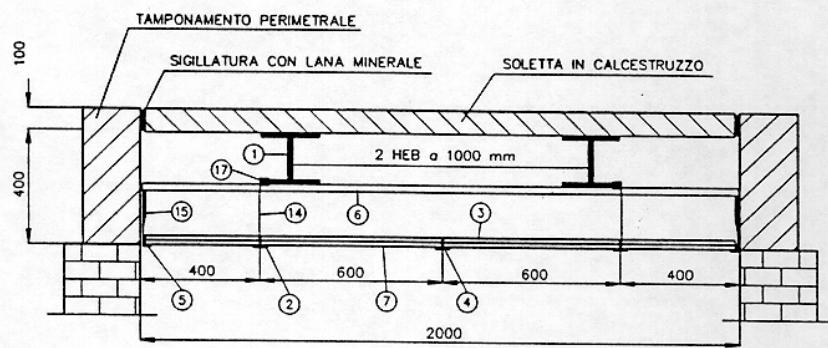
SEZIONE TRASVERSALE DELLA STRUTTURA DEL CONTROSOFFITTO
